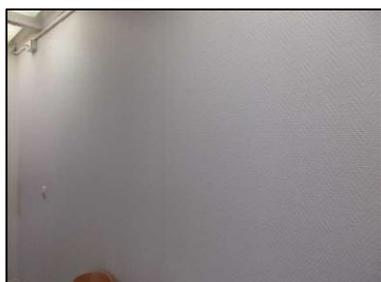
ECH-N°019 RdC mur hall Toile de verre + enduit + peinture
